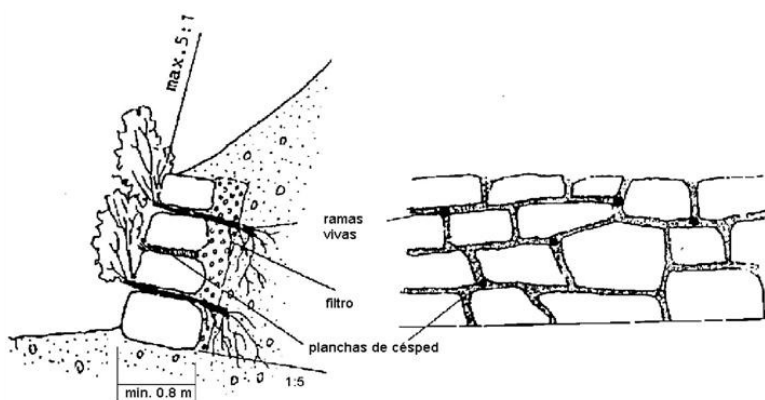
Esquerra: detall constructiu de mur d'escullera amb vegetació (Font: MMAMRM).
